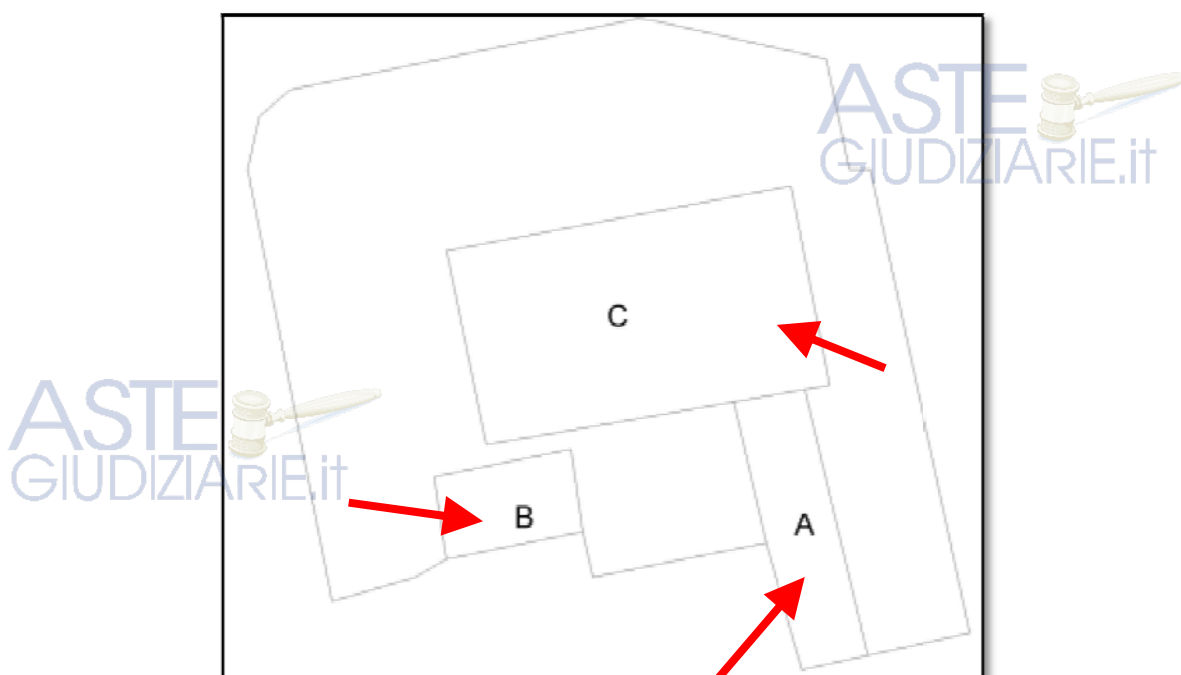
Stralcio della planimetria catastale – elaborato planimetrico dell’opificio Cat. D/1.
